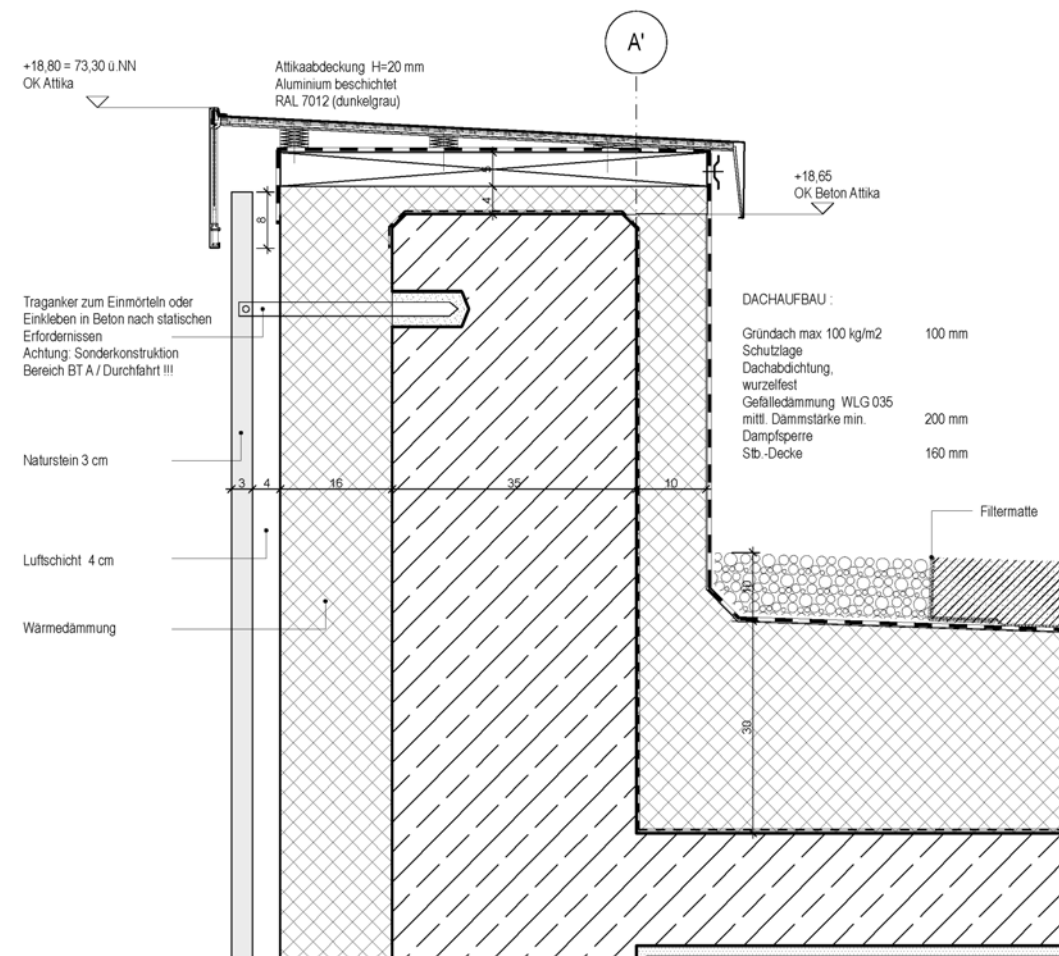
Traufpunkt und Dach: Ausführung und Regeldetail
